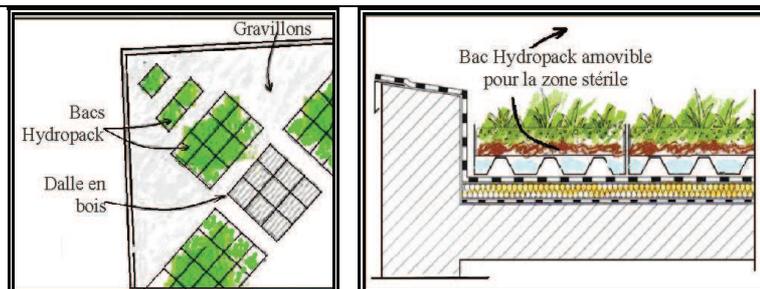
Esquisse d'un plan d'aménagement avec les bacs Hydropack, et coupe sur une zone stérile aménagée avec des bacs amovibles
